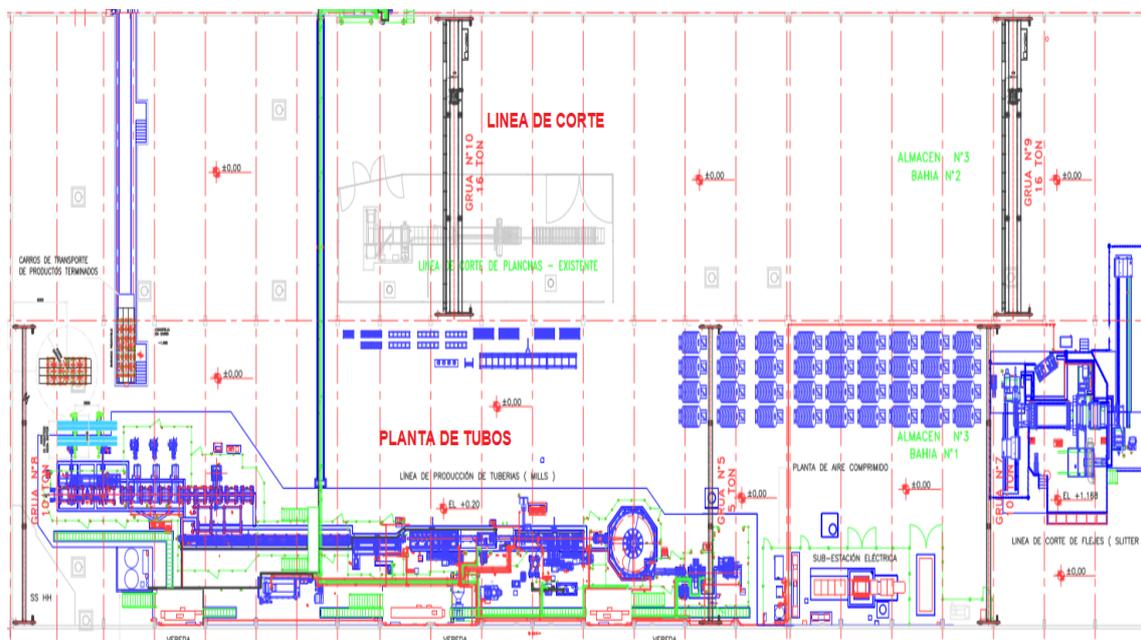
Planta de tubos y Línea de Corte – Autocad
